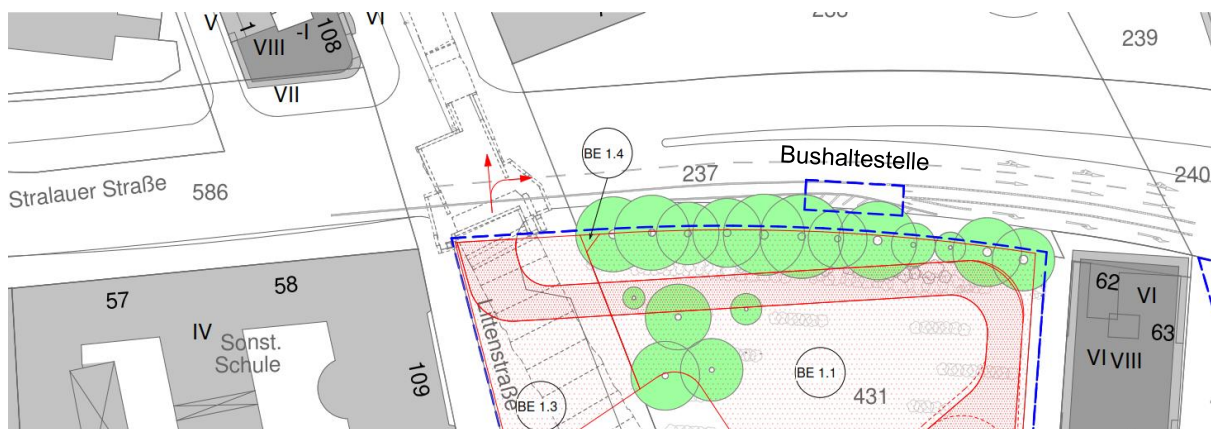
Zufahrtssituation der Baustelleneinrichtungsfläche
